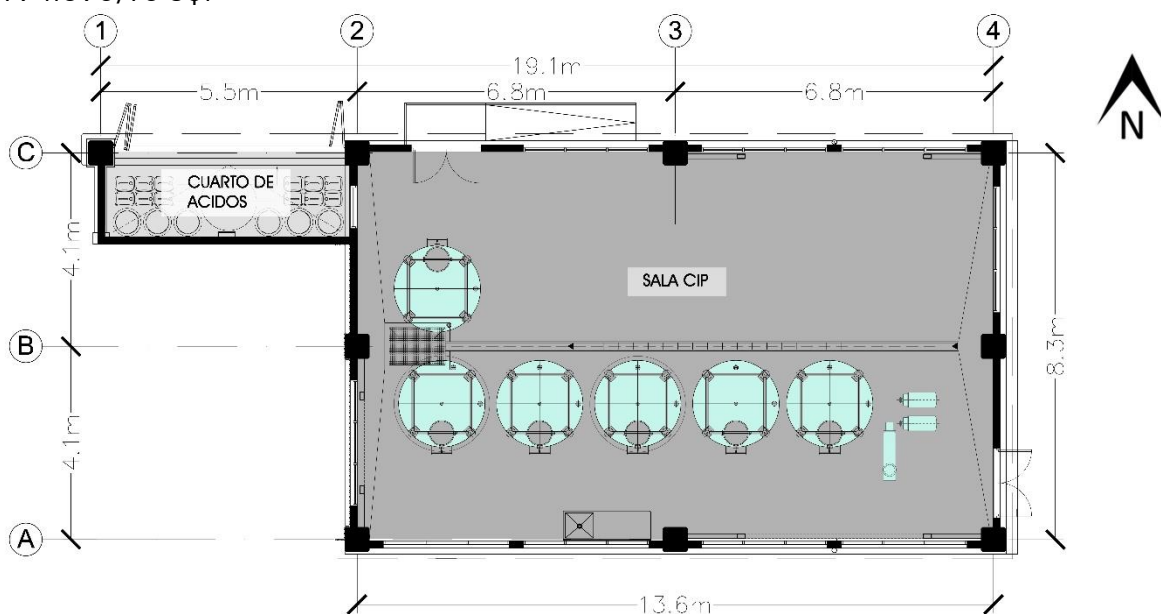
PLANTA ARQUITECTÓNICA SALA CIP.
